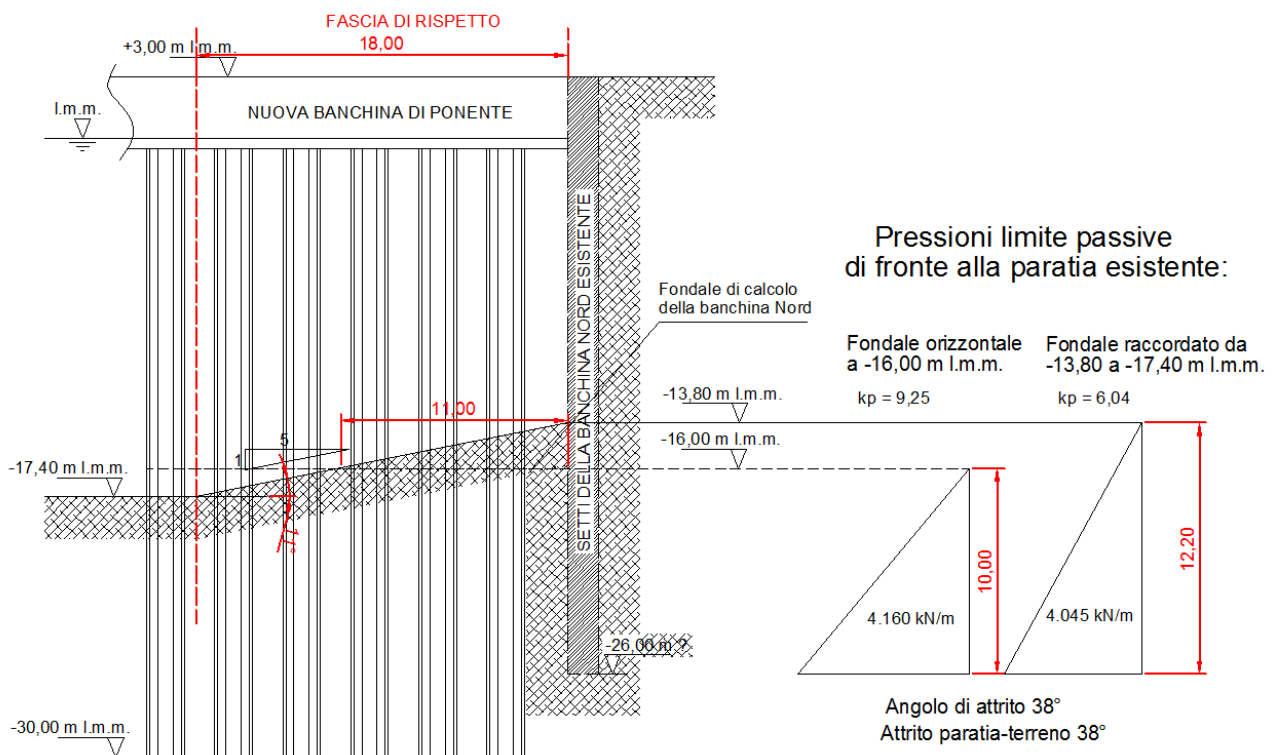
Berma di rispetto da mantenere al piede del banchinamento esistente (banchina NORD)
